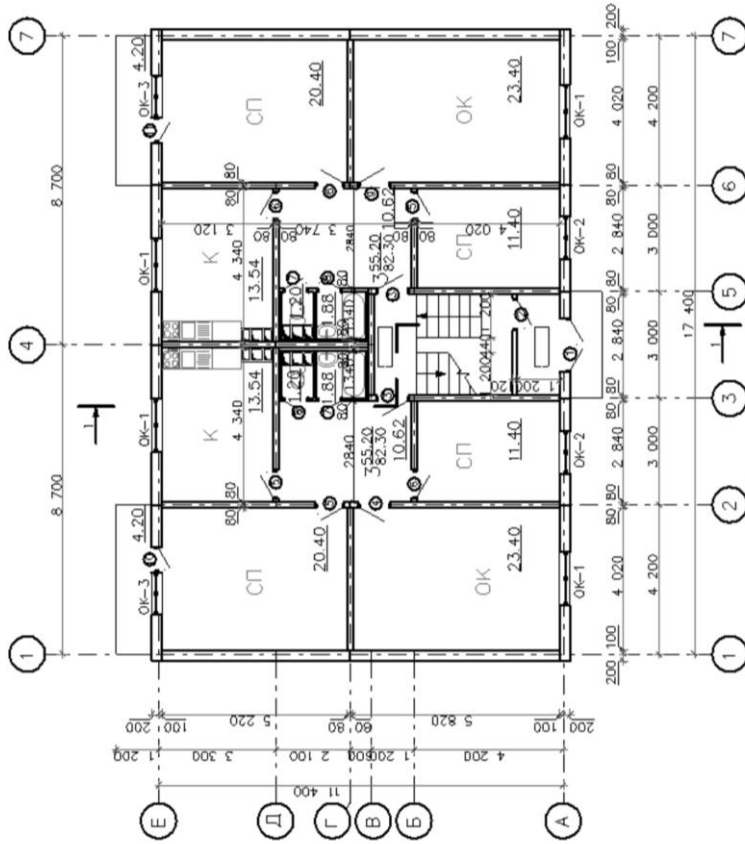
Пример оформления плана 1-го этажа жилого дома со стенами из панелей
